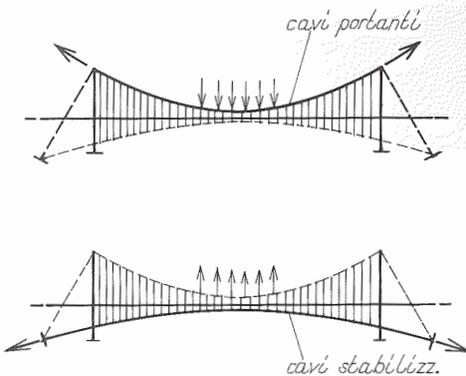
Ponte sullo stretto di Messina, sollecitazioni nei cavi portanti e stabilizzanti.
